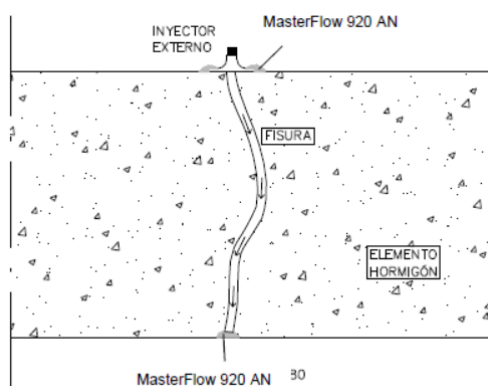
Sellado superficial de una fisura (fuente: Pliego de condiciones – Inyección de fisuras en hormigón EN 1504-5, de Master Builders Solutions)
